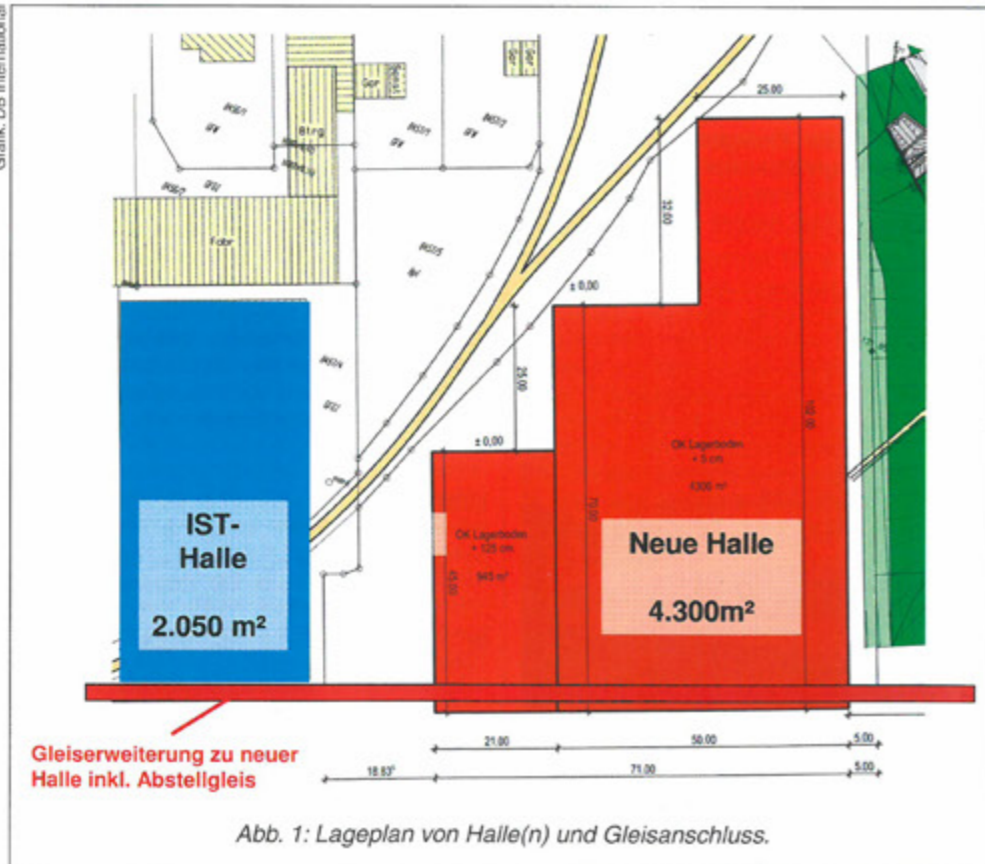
Lageplan von Halle(n) und Gleisanschluss.
